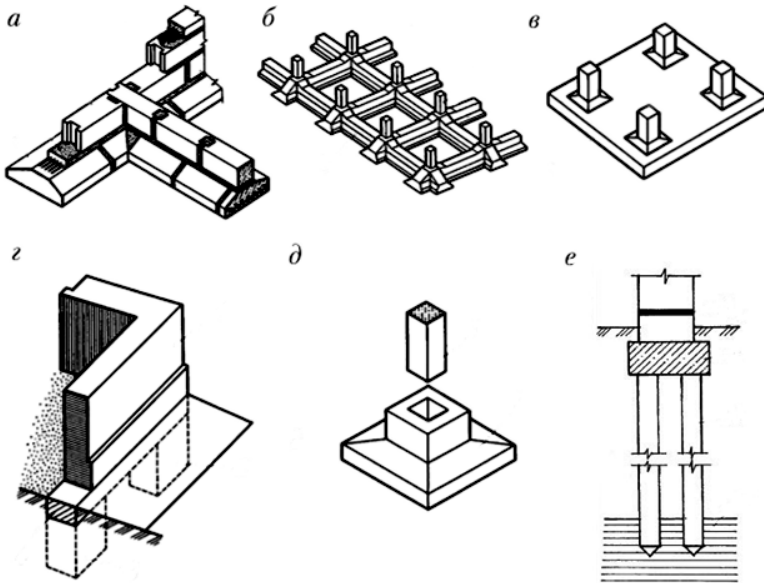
Виды фундаментов: *a* – ленточный под стены; *б* – ленточный под колонны; *в* – сплошной под колонны; *г* – столбчатый под стены; *д* – отдельный под колонну; *е* – свайный
